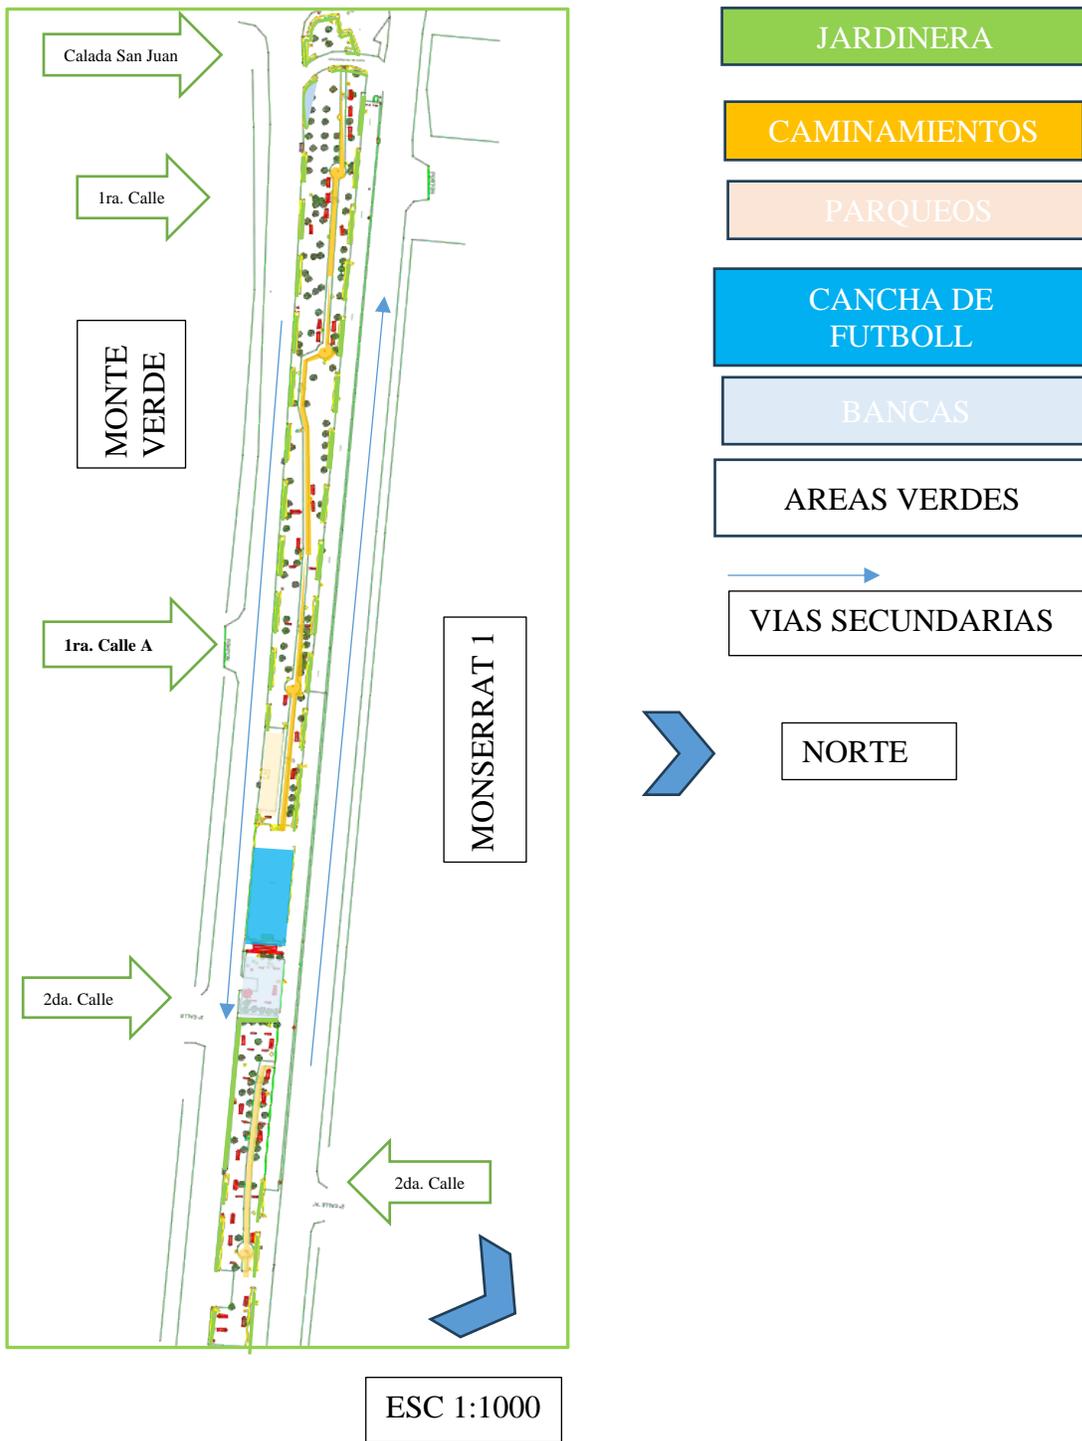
sector 1 existente, entre la Calzada San Juan a 3.ª calle, zona 4 de Mixco
